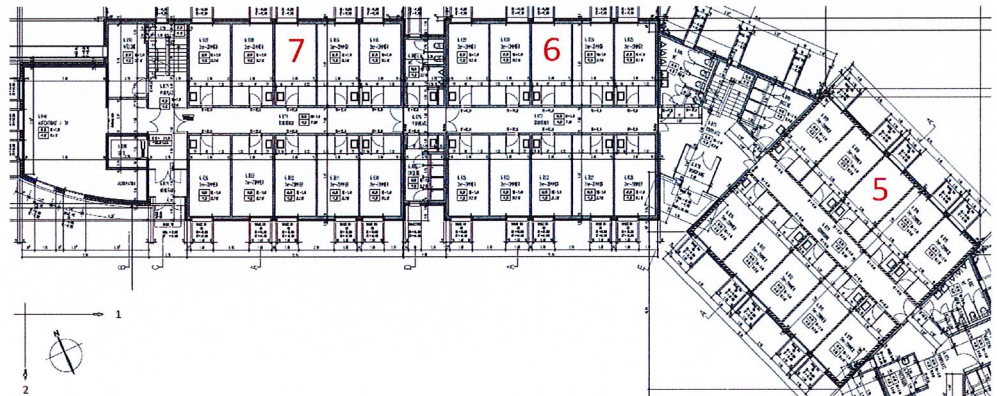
Situationsplan Gebäude WG (Darstellung EG)
